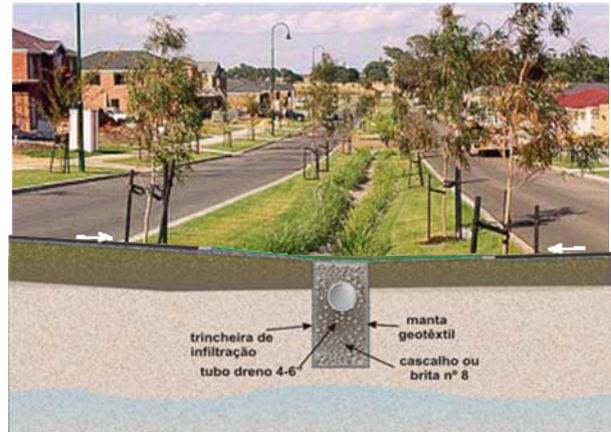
Trincheira de infiltração em canteiro central – WSUD
